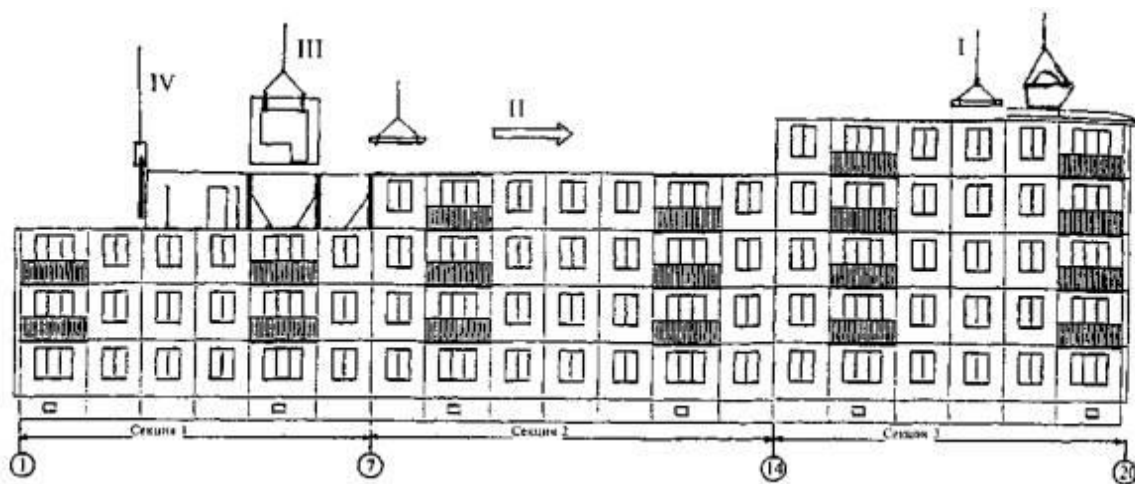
Технологическая последовательность поэтажного демонтажа конструктивных элементов крупнопанельного жилого дома
